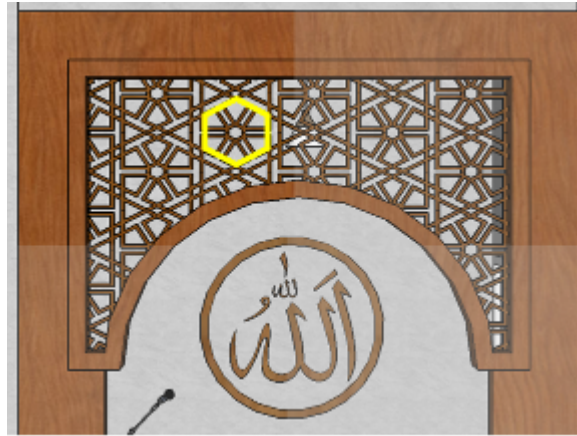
Desain Ruang Sholat Jamaah Wanita
